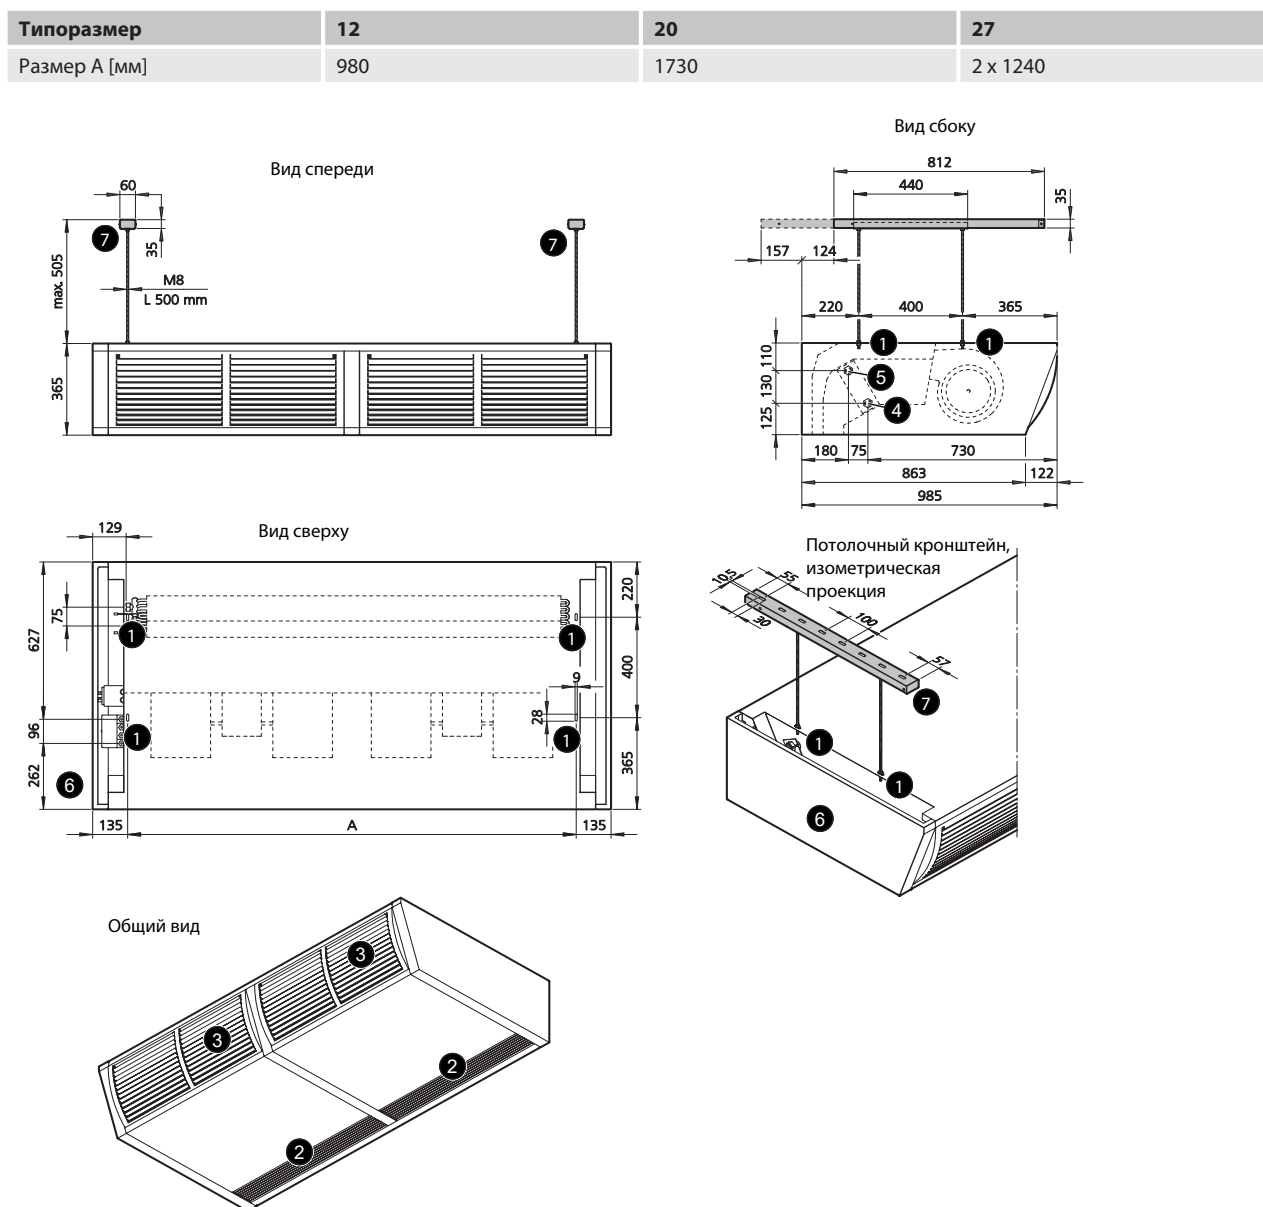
Точки для подвешивания прибора Tandem 365, типоразмеры 12 - 27 с потолочными кронштейнами
